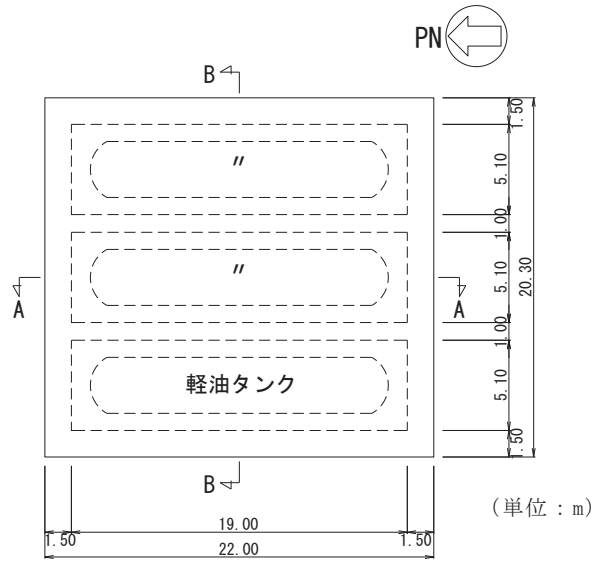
ガスタービン発電設備軽油タンク室平面図
